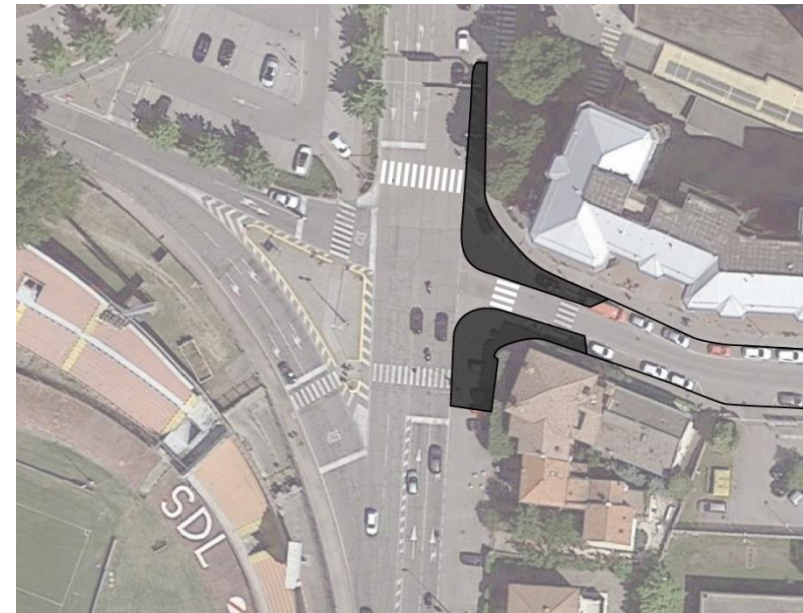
Schema della riconfigurazione dell'intersezione Piazzale di Porta Ceresè - Via Grossi.
